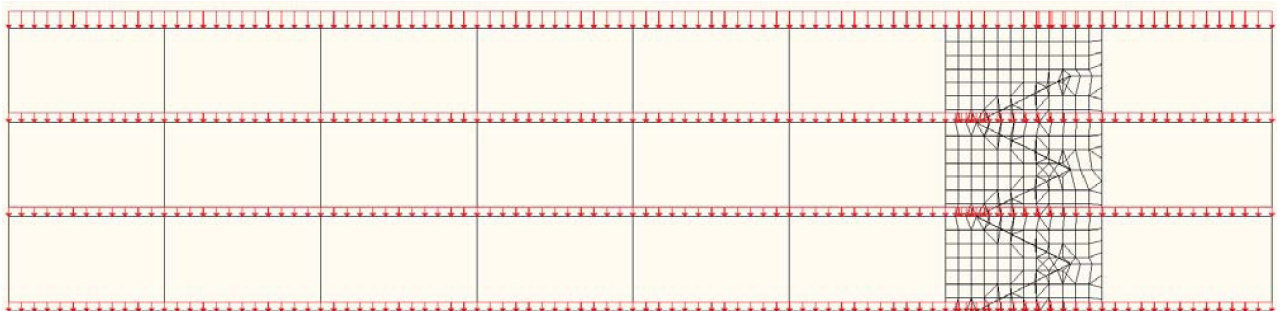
Схеми завантажень будівлі від ваги підлог і покрівлі
